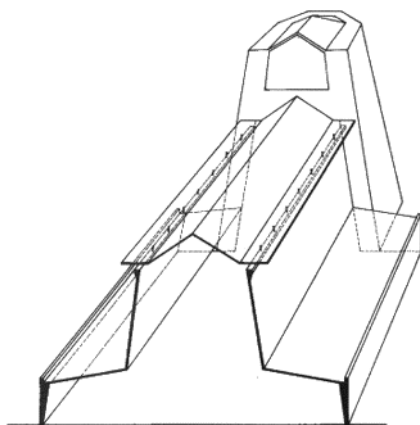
Igreja de São Pedro. Esquema estrutural em perspectiva.
